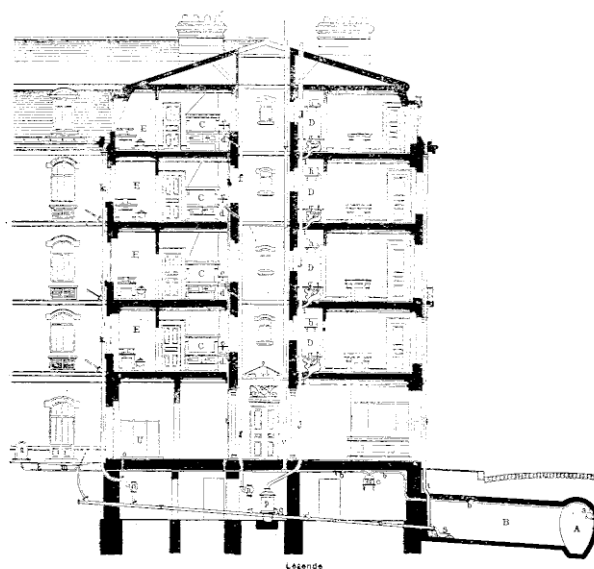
Service de l'Assainissement. (Coupe en travers d'une Maison desservie par le Système diviseur.)
